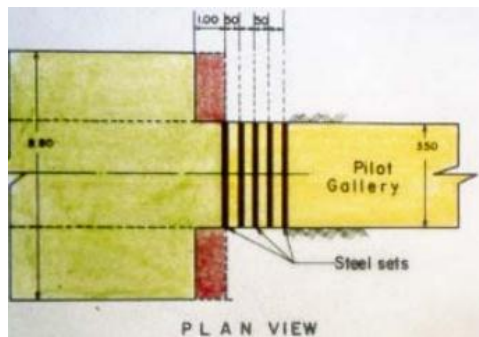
Planta del inicio de excavación de la galería piloto.
